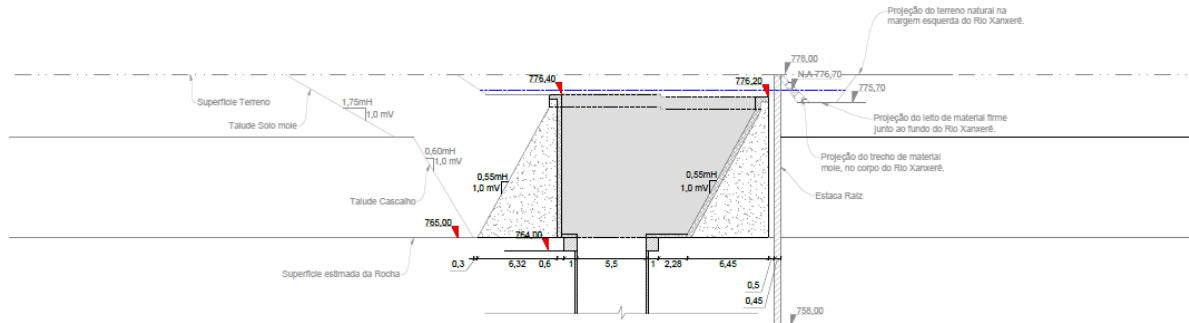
Planta do muro - emboque do túnel desenho (PMX-B-TUDE-0017-0).
